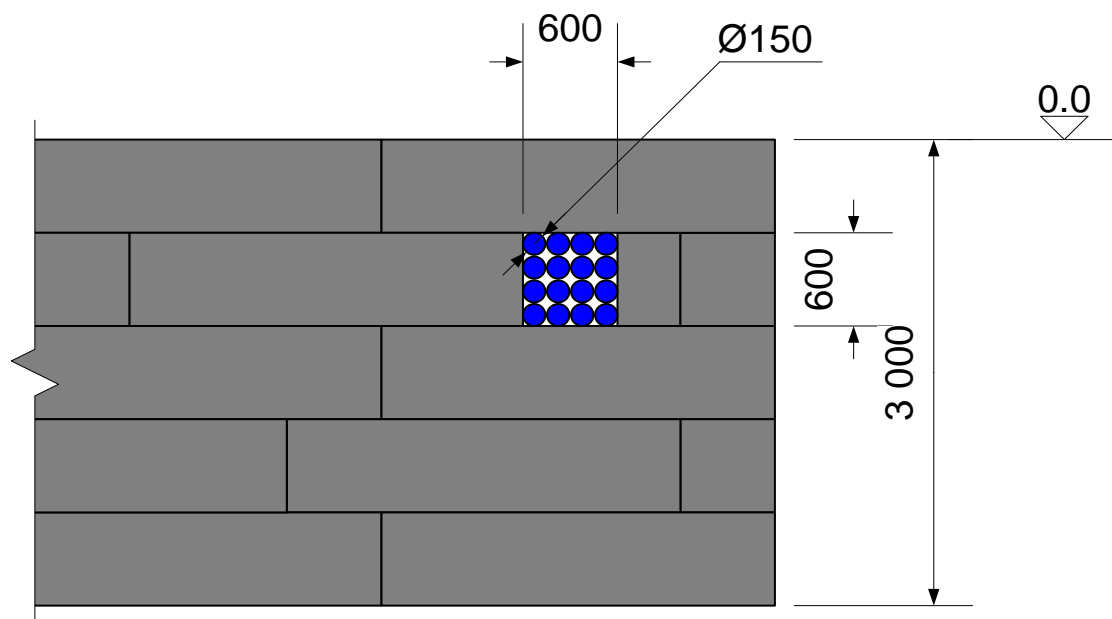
Вывод КЛ-10 кВ через фундамент здания подстанции
